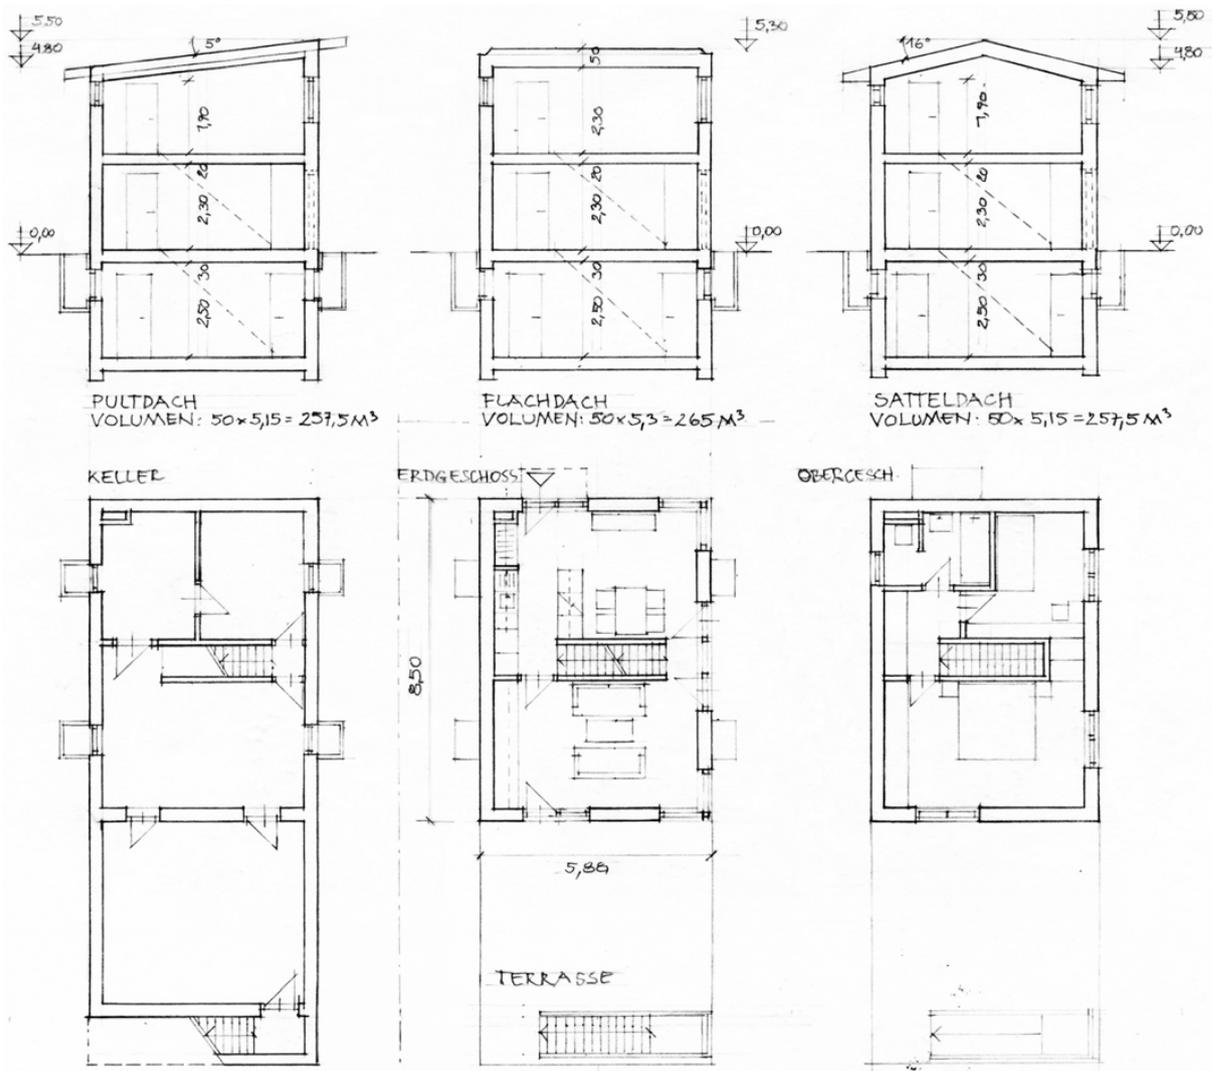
Grundrisse und Schnitte mit Kubatur
